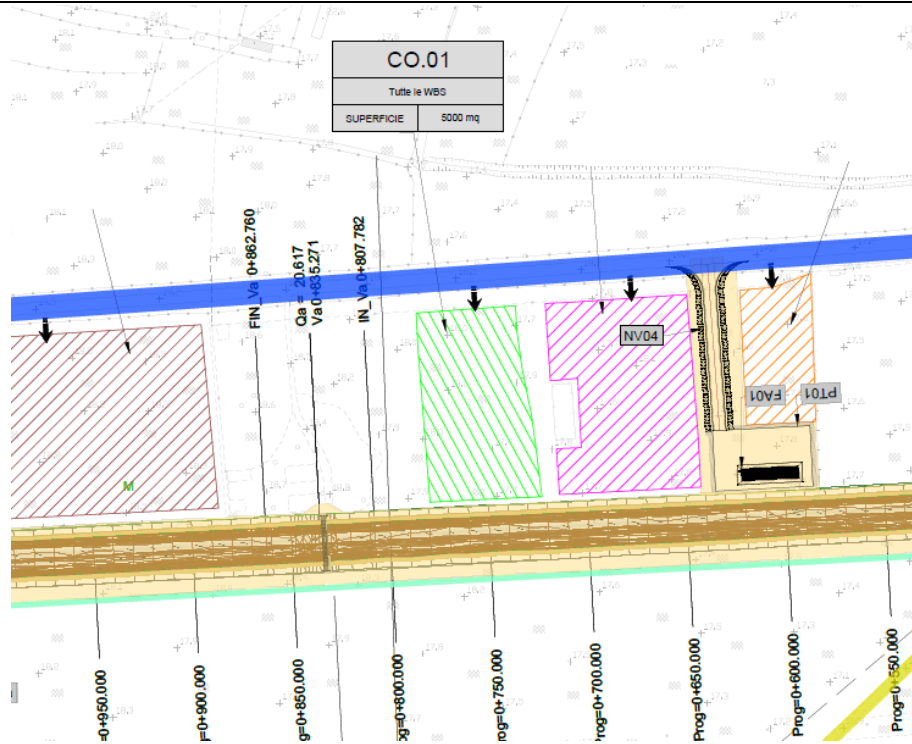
Vista in pianta dell'area di cantiere SP90
